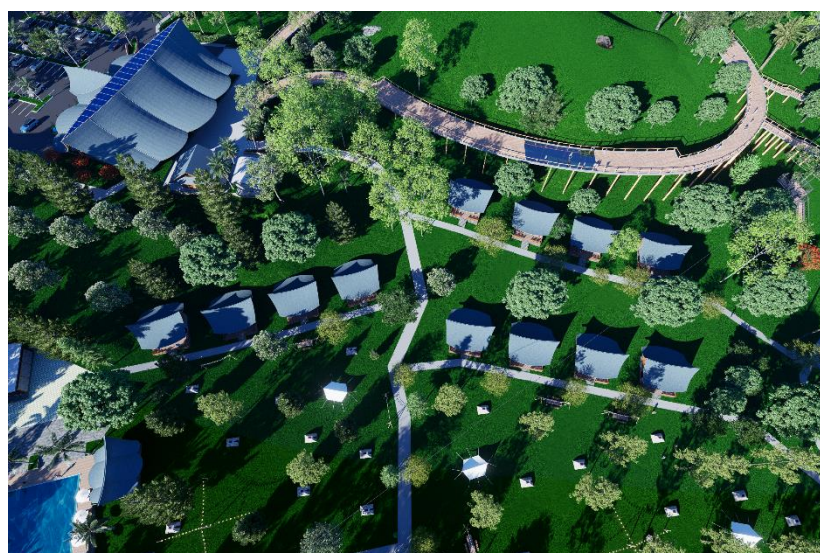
Konsep Bangunan Retail Caffee dan UMKM
